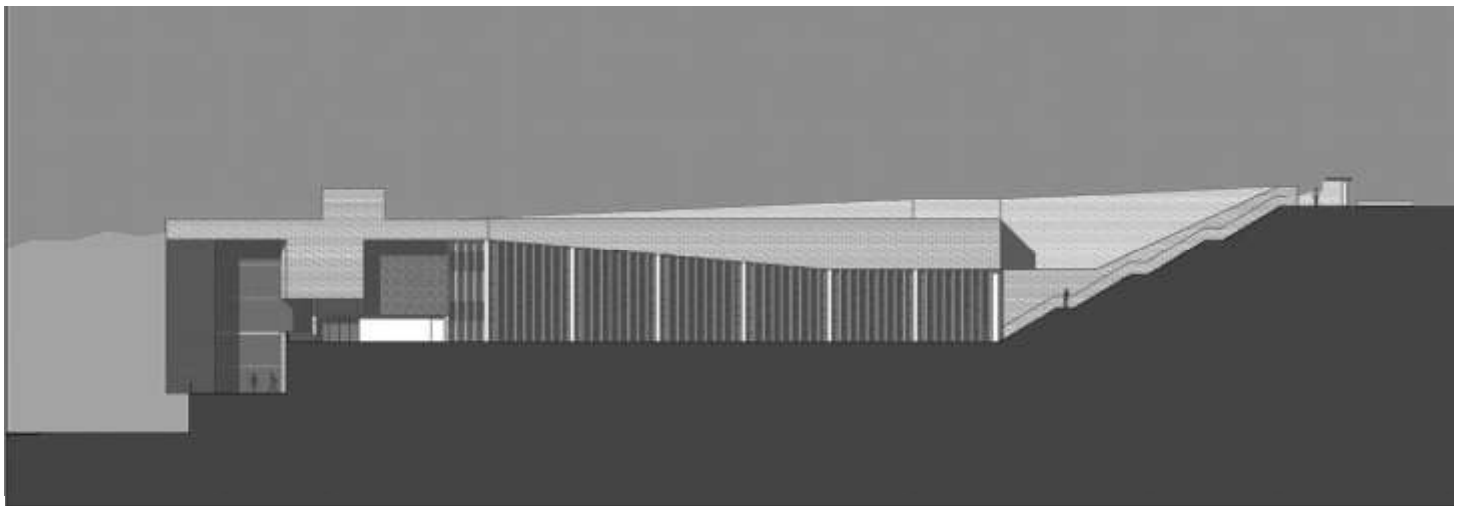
LUM. Elevación fachada sur. Estudio Barclay & Crousse
